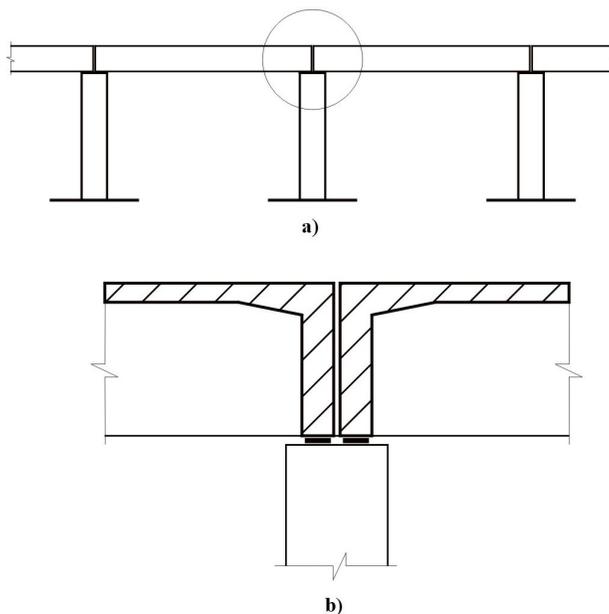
Ponte em vigas simplesmente apoiadas com diversos vãos:
